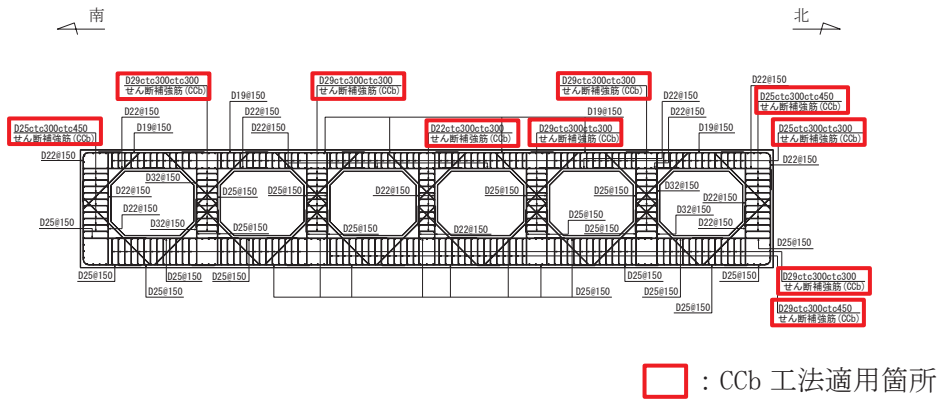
取水口概略配筋図 (B-B 断面, 漸縮部)
